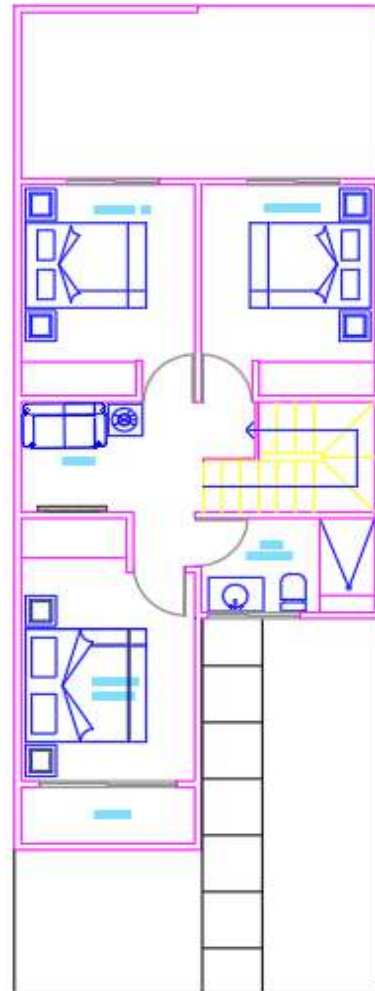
plantas Arquitectónicas de la vivienda ubicada en la calle Allende No. 5 colonia centro en Huandacareo Mich. Nota: la ampliación se hizo en un terreno de aproximadamente de 36 m².
